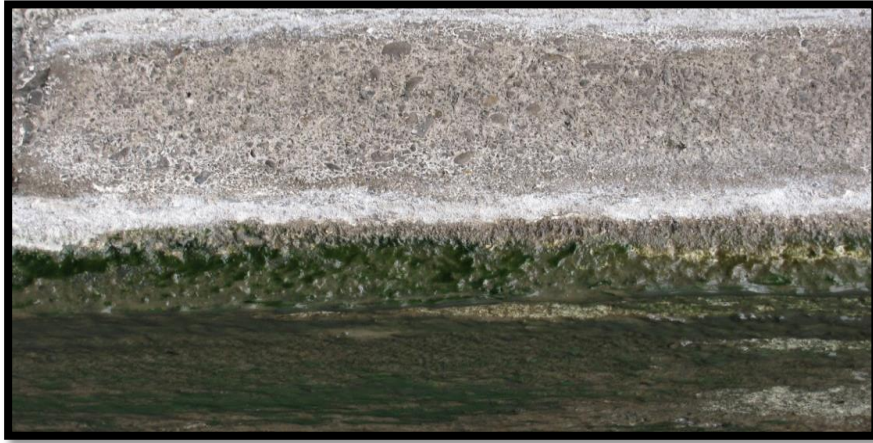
Fotografía detalle del estado de la viga sobre columnas en el costado occidental (Fuente: el autor).
